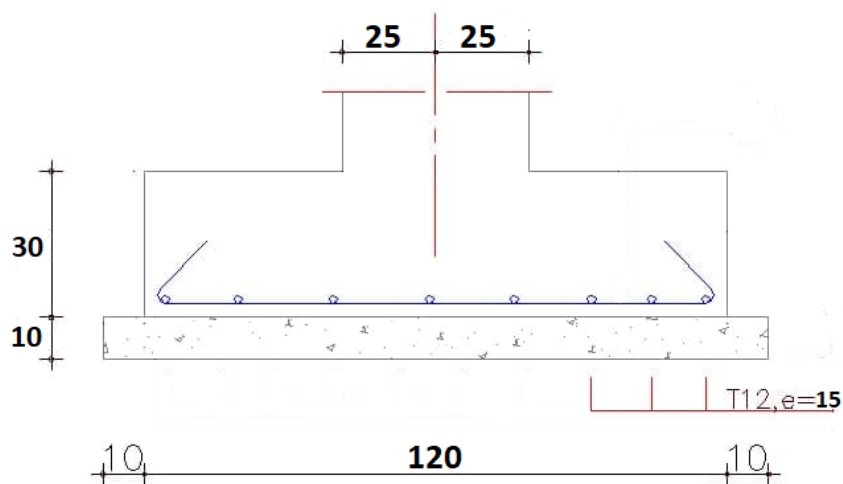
ferrailage de la semelle isolée par Autocad 2012.
